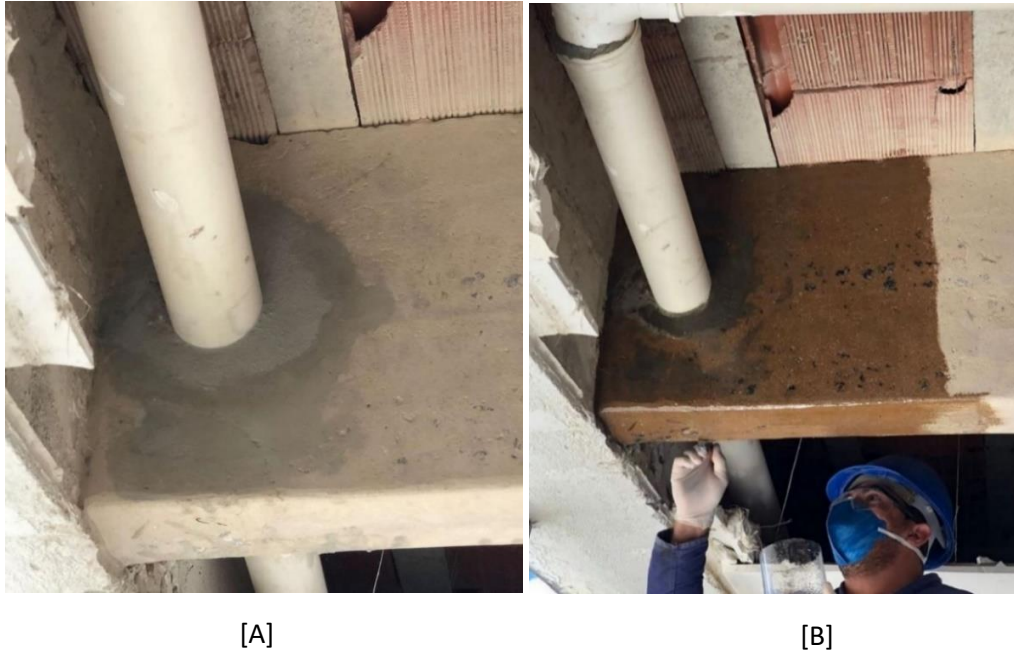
[A]-Preenchimento dos Vazios com argamassa estrutural [B]- Aplicação da Resina Primer
